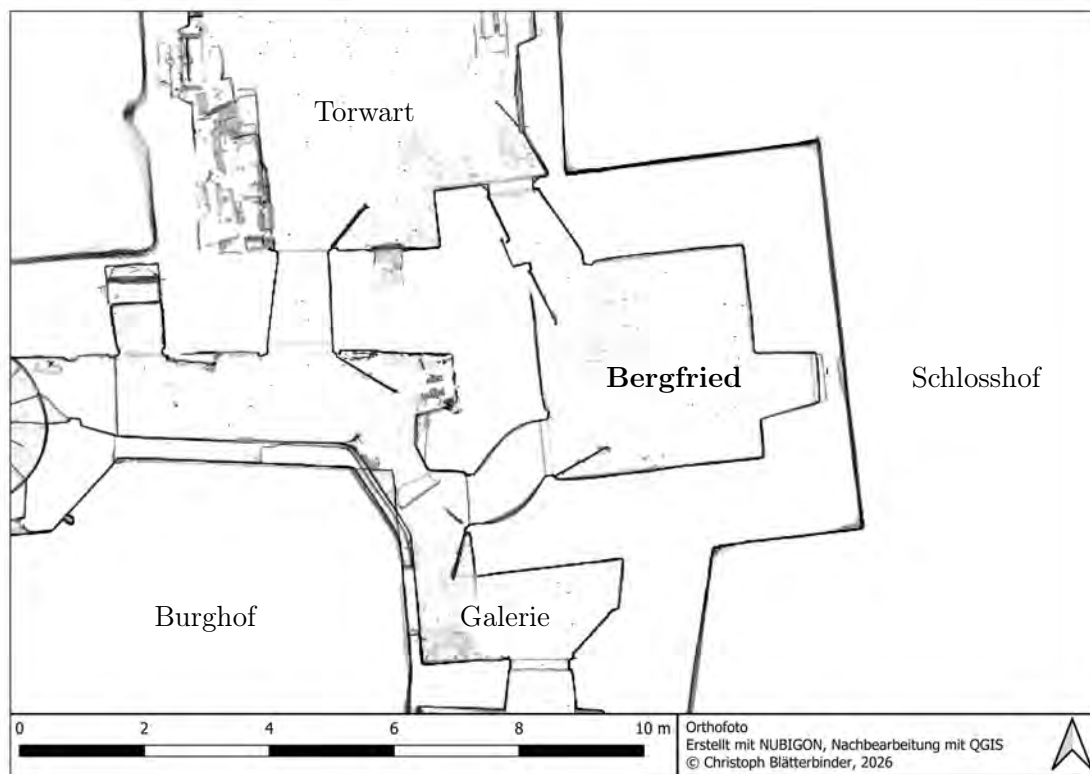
Plan des Bergfrieds, 1. Obergeschoss.
